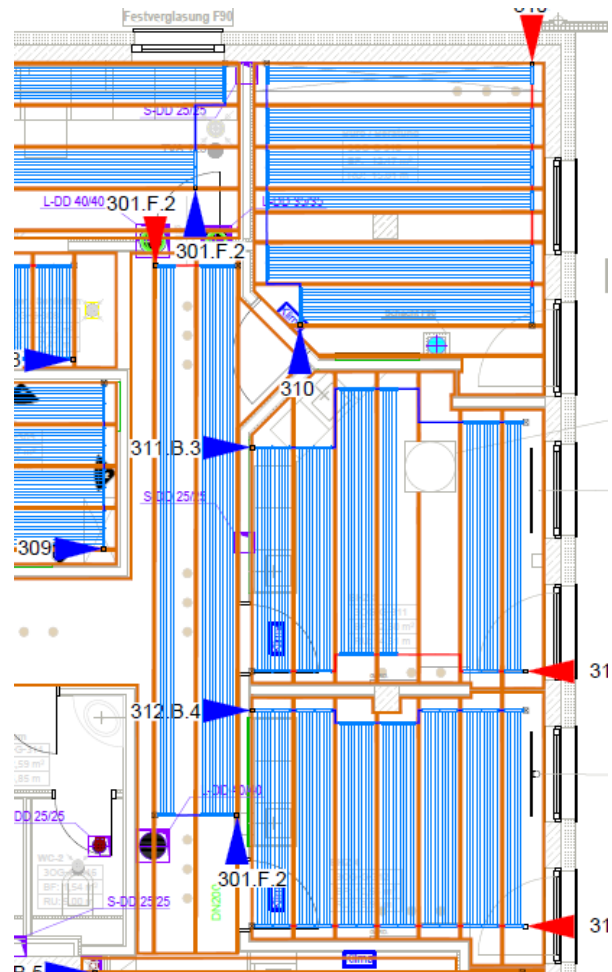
Darstellung mit Unterkonstruktion und Belegung
